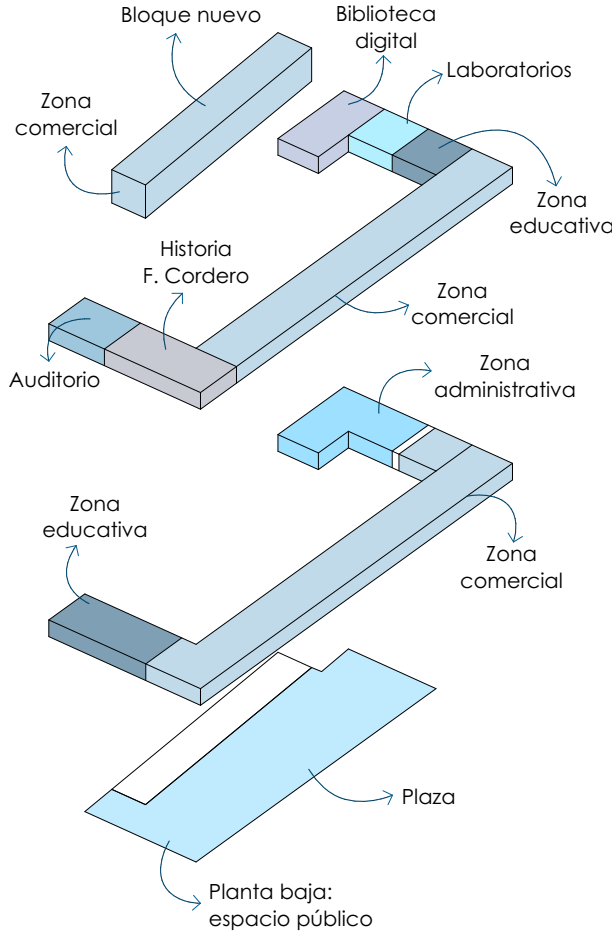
Volumetría propuesta por la Fundación Barranco. Nota. Anteproyecto de la Fundación Barranco. Elaboración propia.
